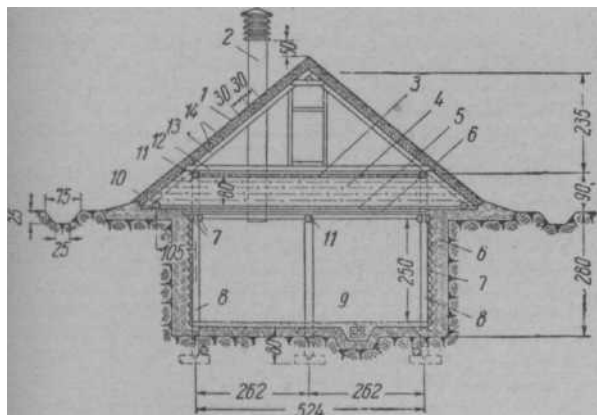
Типовой подземный зимовник: 1 — глиносоломенная кровля; 2 — верхний вытяжной канал; 3 — слой сухой земли; 4 — утепляющий слой соломенной резки; 5 — песок; 6 — глина; 7 — пластины; 8 — стойка; 9 — приточный канал; 10 — лежень; 11 — прогон; 12 — ригель; 13 — стропила; 14 — жердевая обрешетка (размеры в см).
